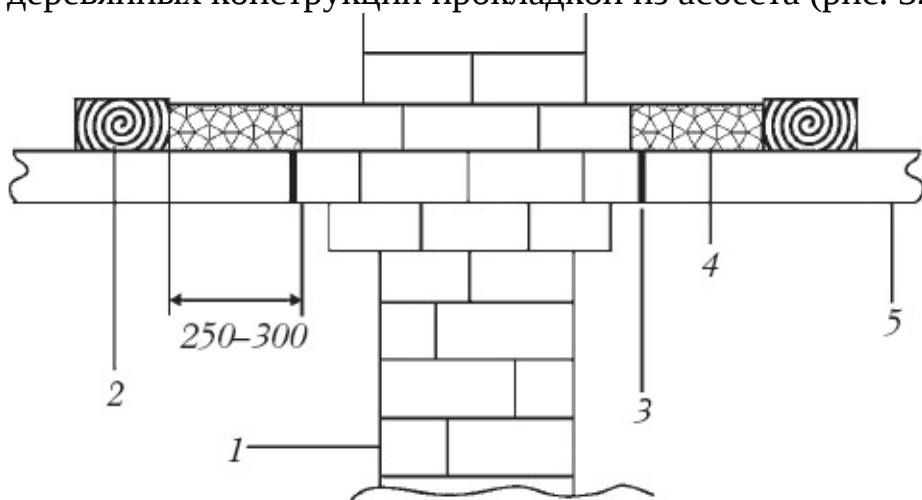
Утепление потолка вокруг печной трубы (размер указан в миллиметрах): 1 – дымоход; 2 – балка; 3 – асбест; 4 – утеплитель; 5 – потолок
